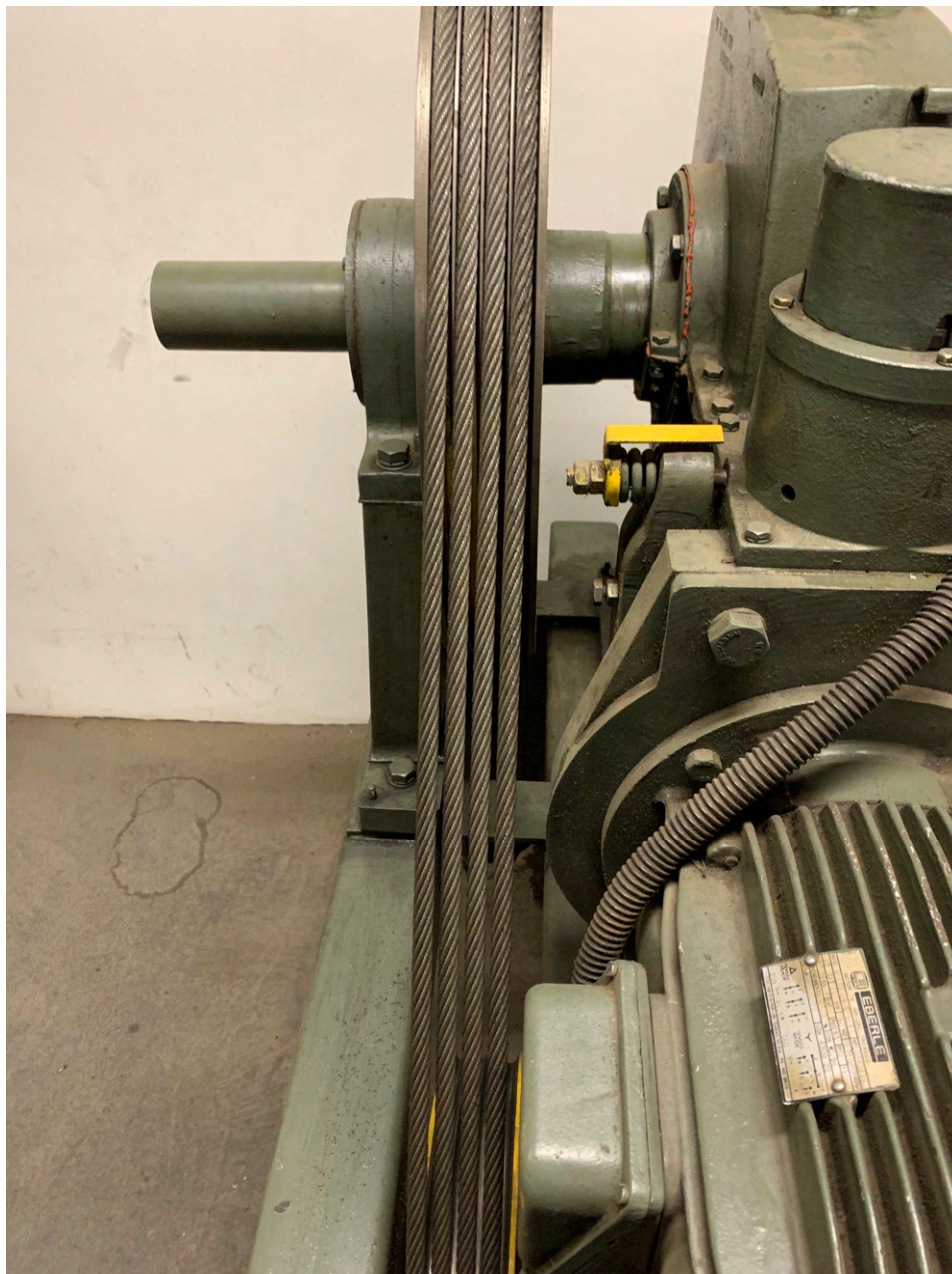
CONJUNTO DE TRAÇÃO DOS ELEVADORES
